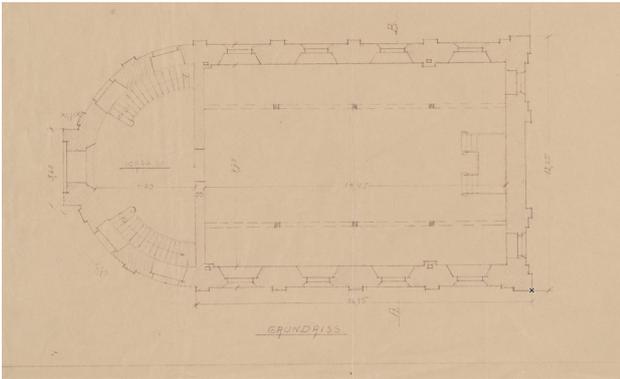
Herder_Institut_Grundriss_Zagan
